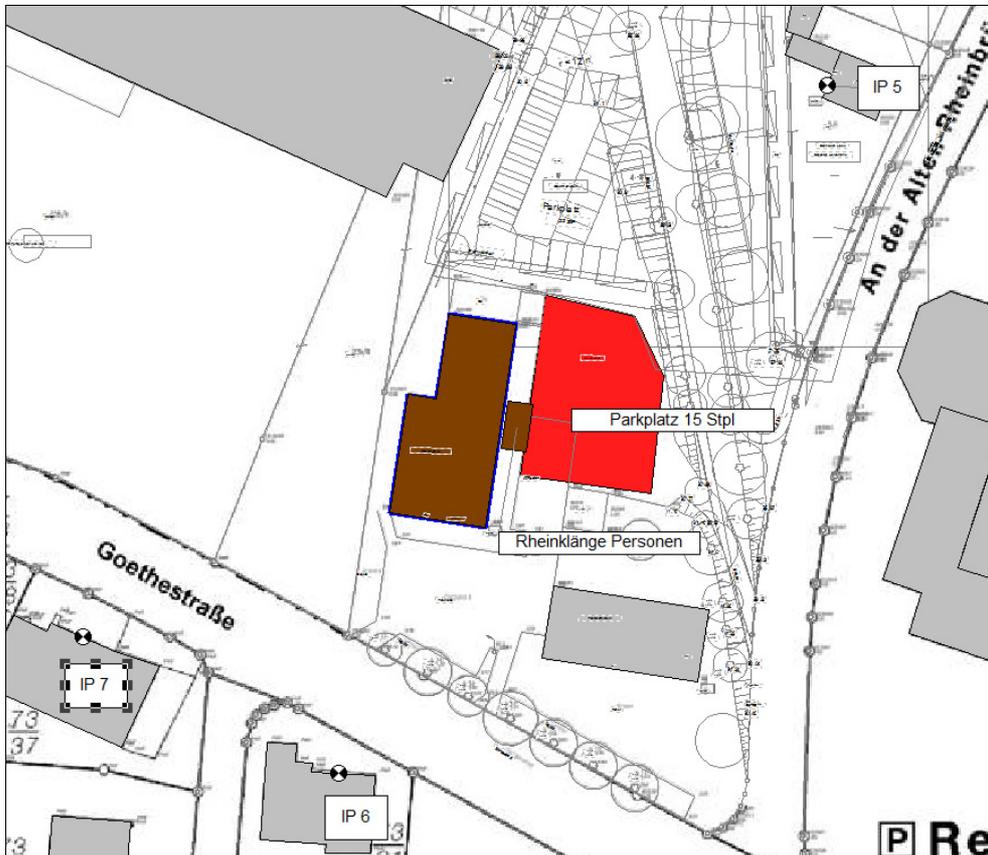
Lageplan mit Kennzeichnung der berücksichtigten Quellen
